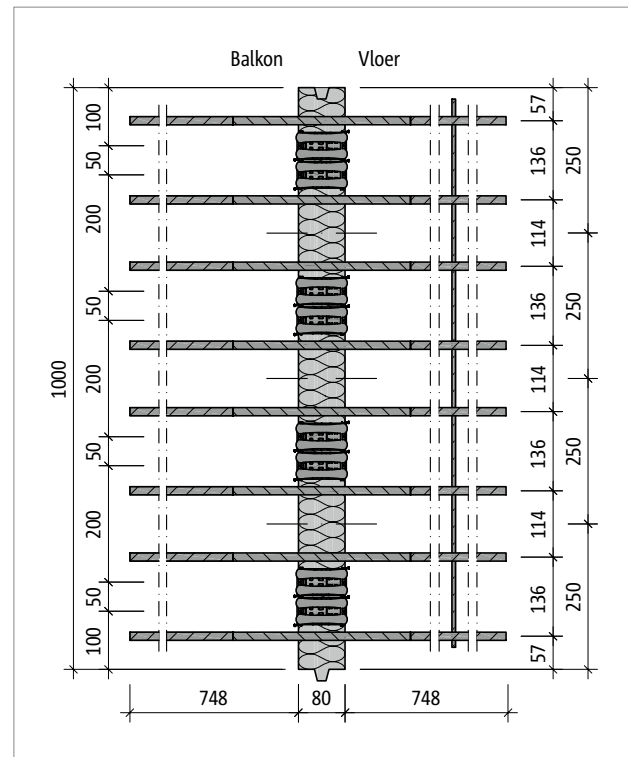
Schöck Isokorb® T type Q-E-V6: Doorsnede
